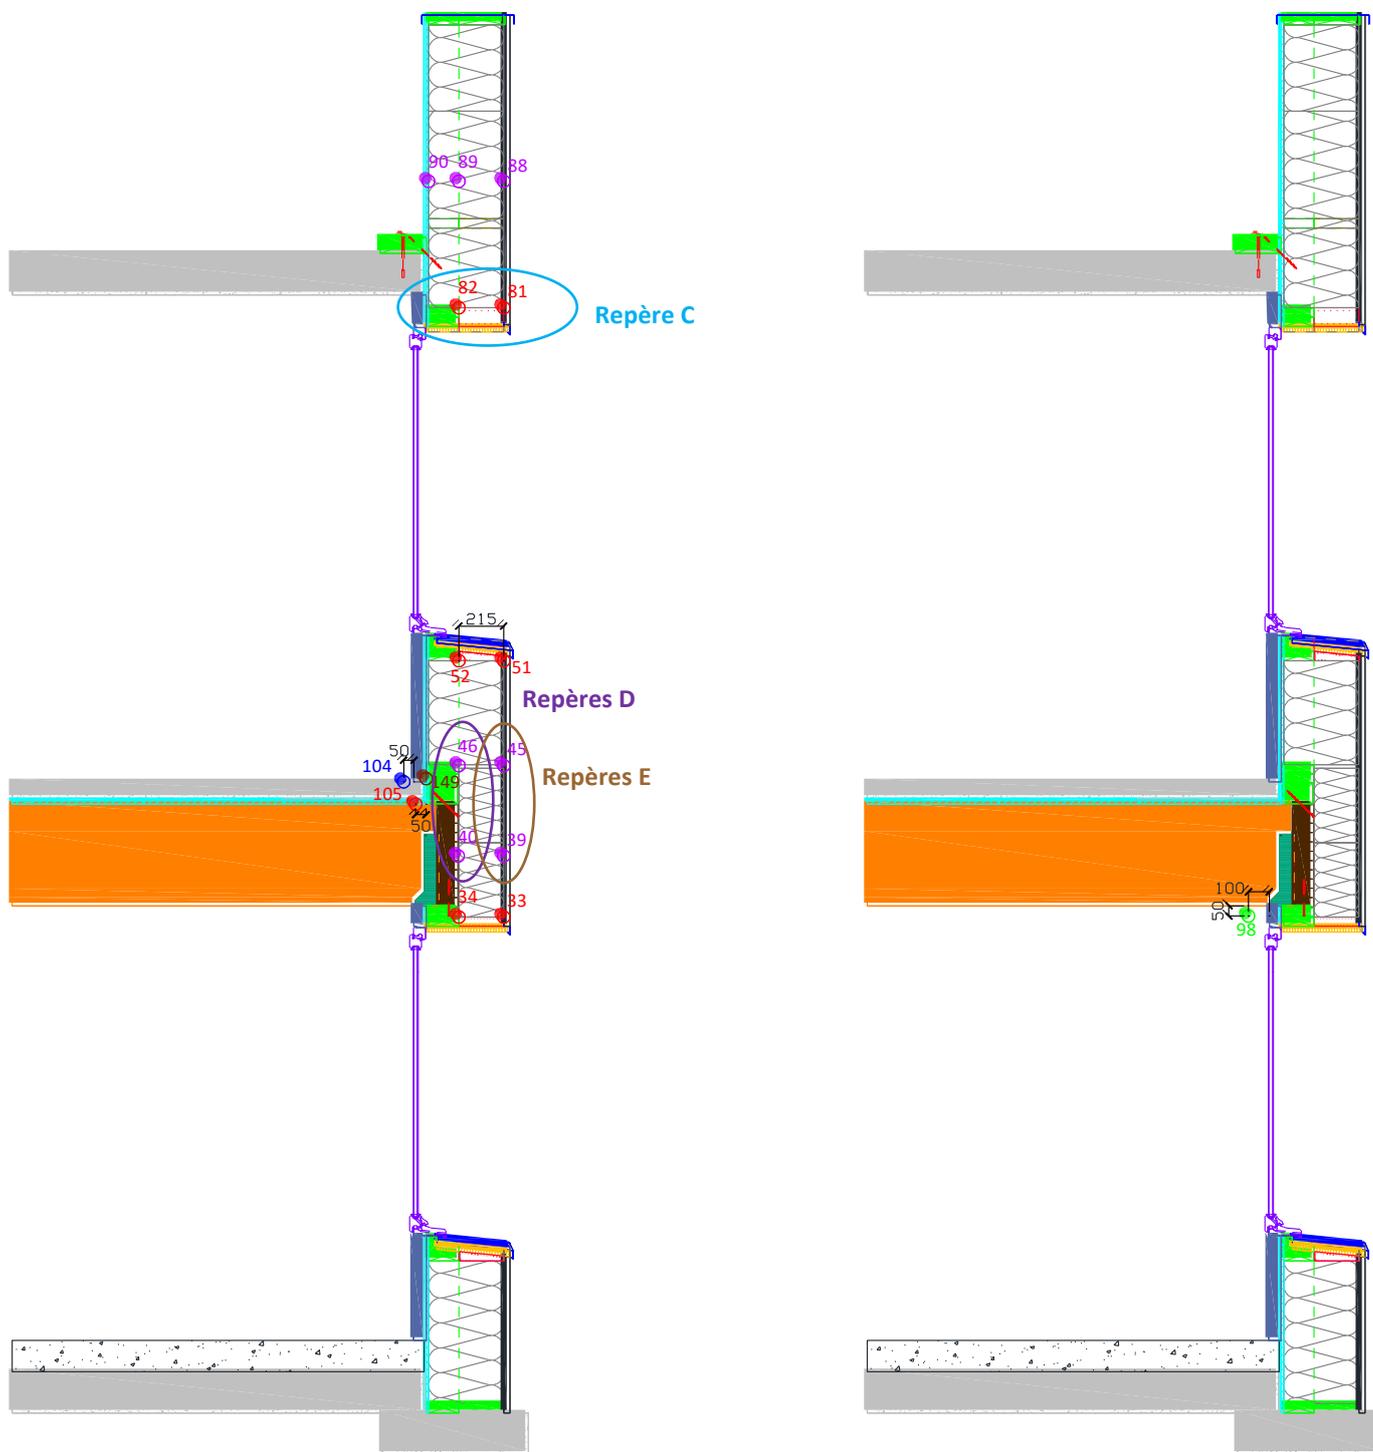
Instrumentation de l'élément de façade - (A gauche) : Coupe C-C - (A droite) : Coupe D-D
